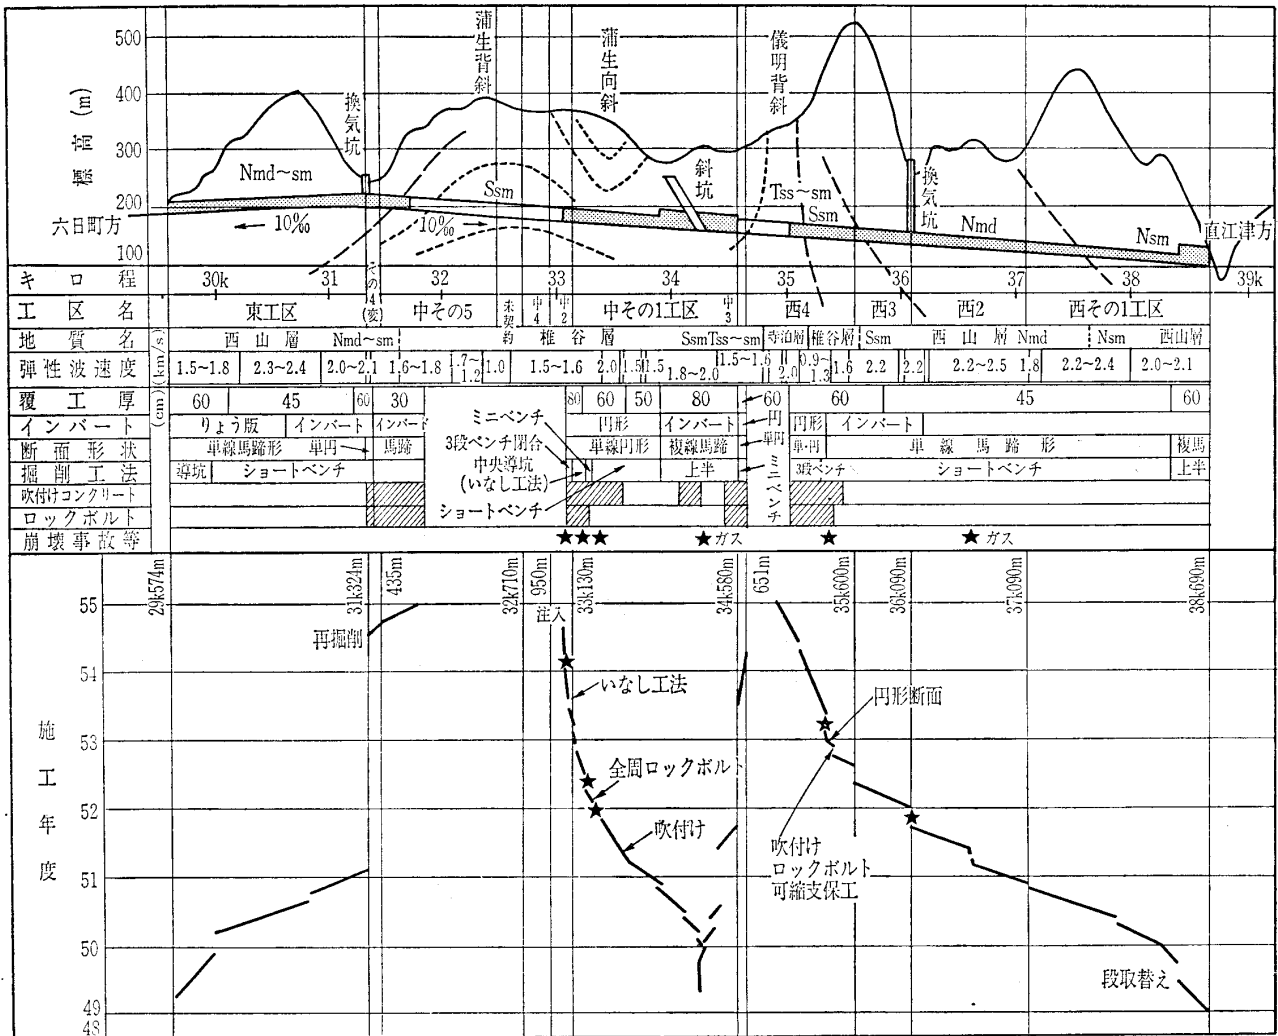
鍋立山トンネル地質縦断と施工実績
